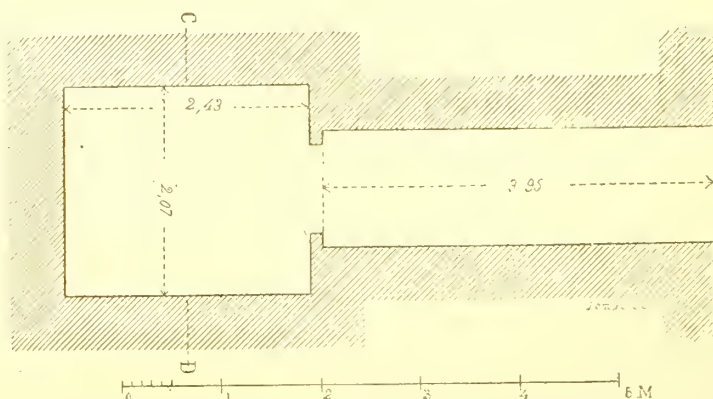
TÚMULUS DE ASSARLIK. - PLANTA, SEGÚN PATON
